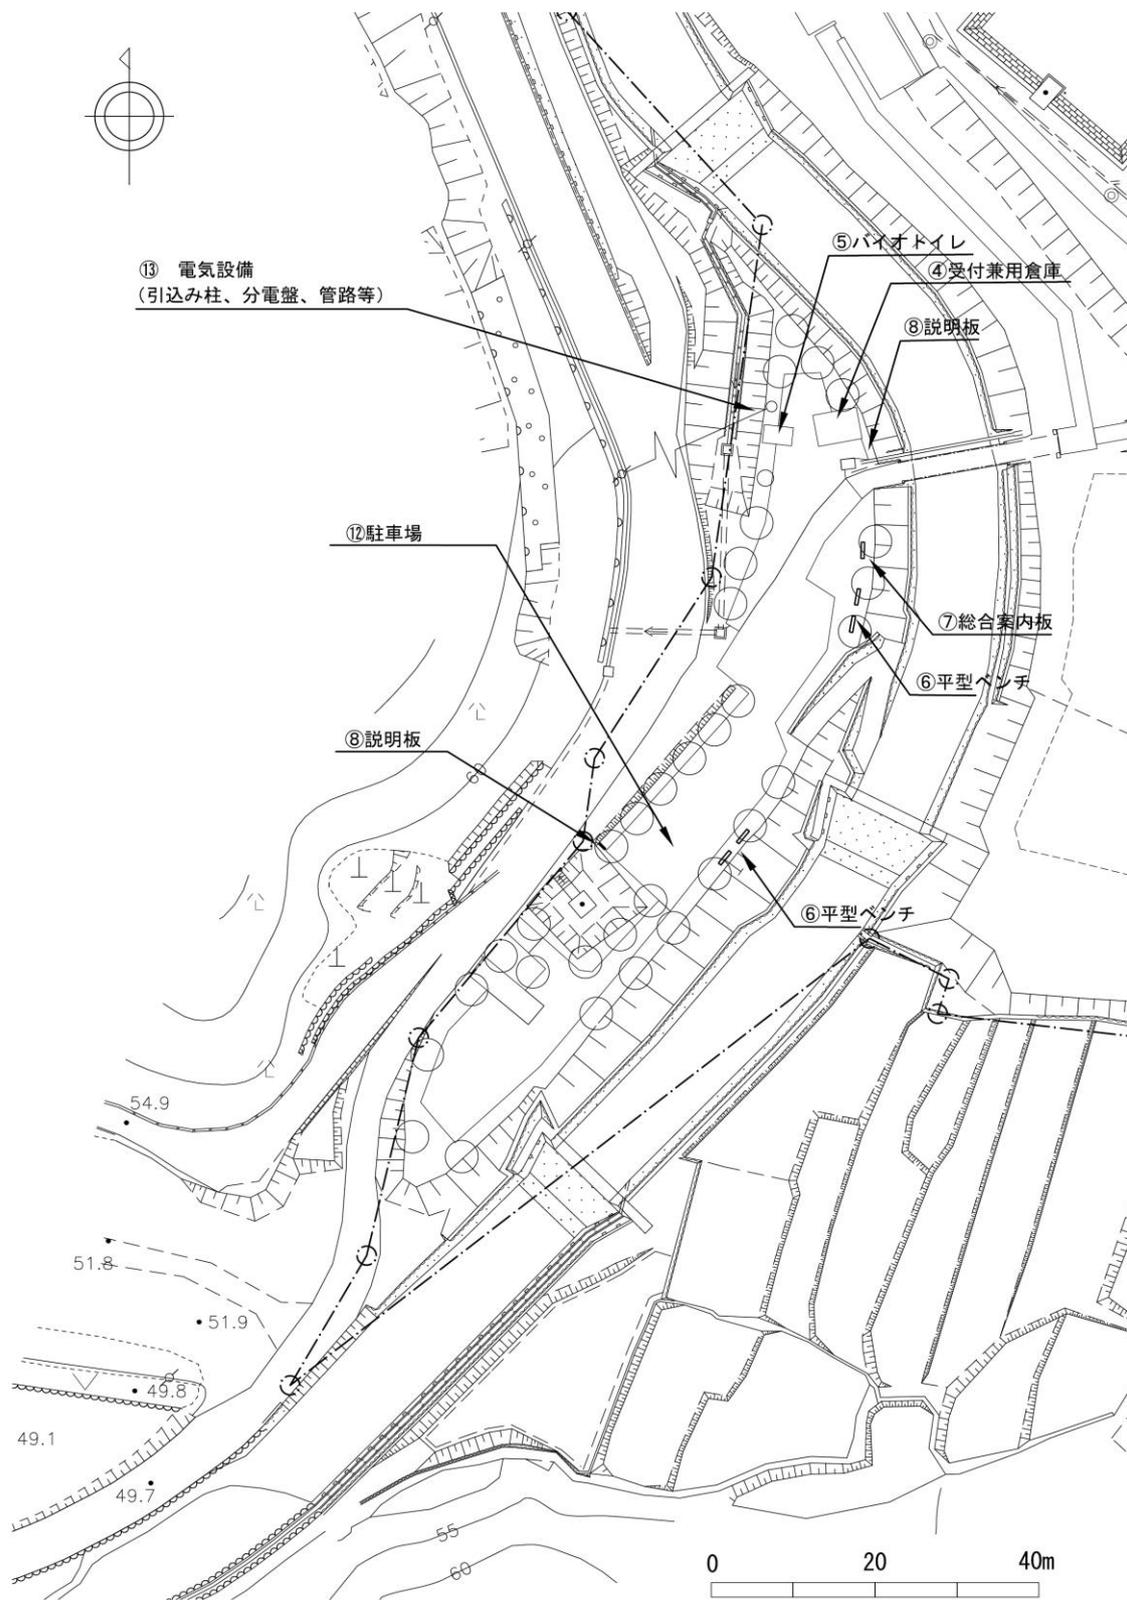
活用施設配置図 (エントランスゾーン拡大図)
